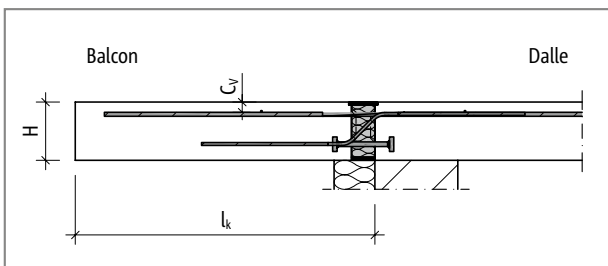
Schöck Isokorb® T Type K-M12 : Système statique
